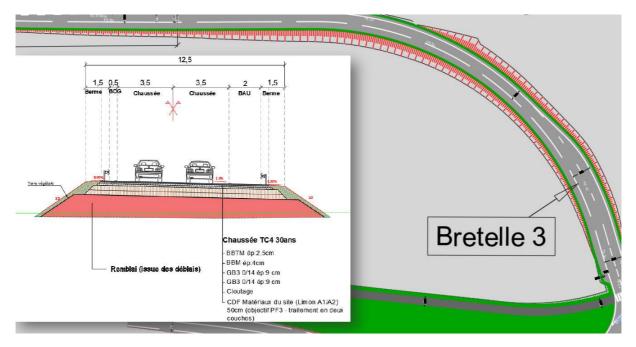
Plan de la bretelle n°3 de la solution retenue pour le projet
